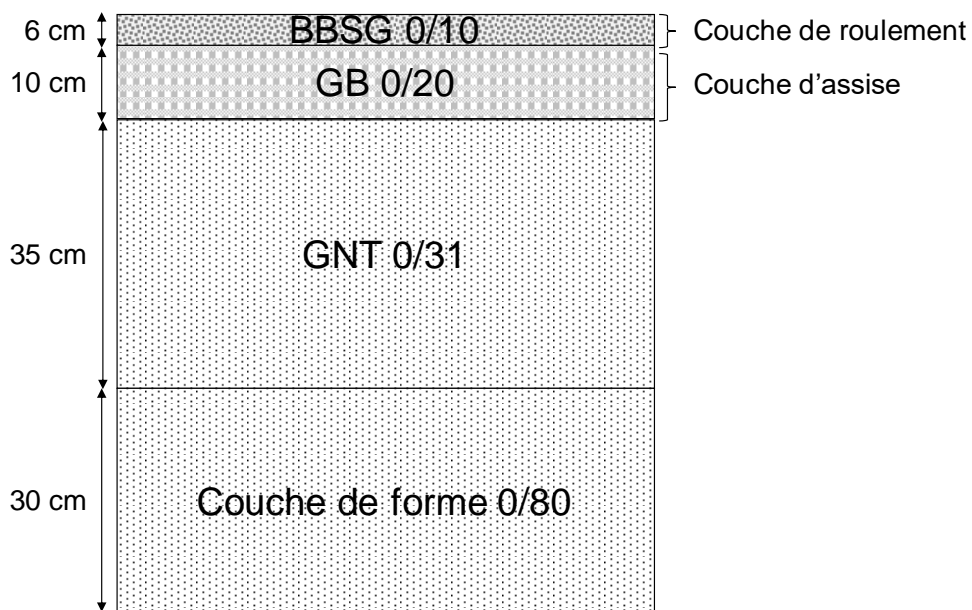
Structure de chaussée pour le site de Béziers (D14)
